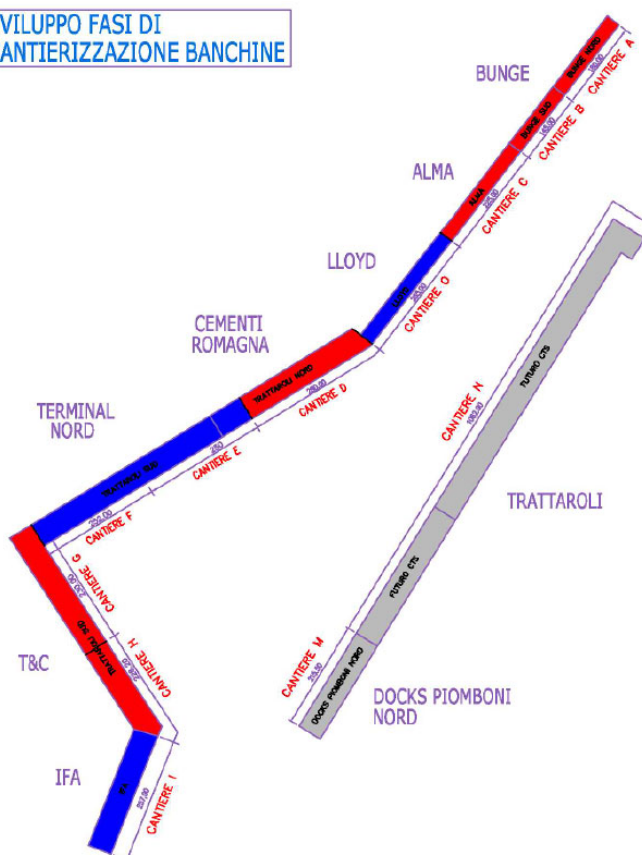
Sviluppo Fasi di cantierizzazione banchine
